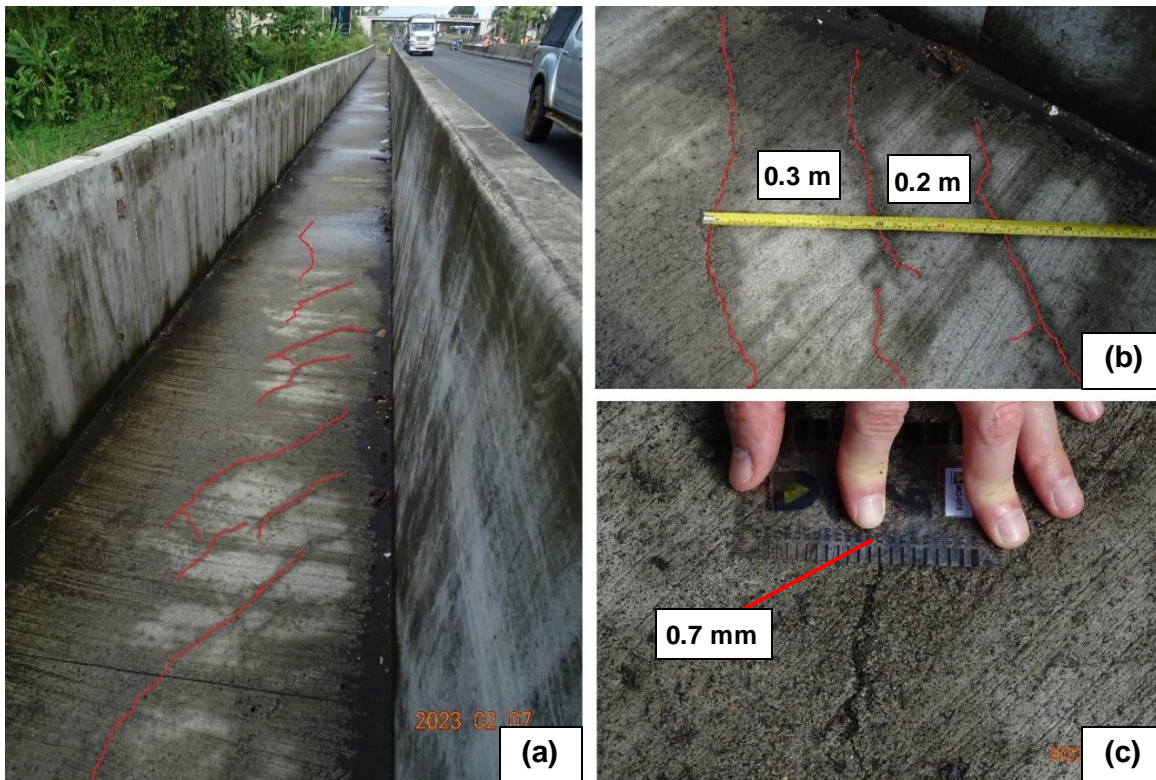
Agrietamiento de la sobrelosa de concreto del tablero del puente nuevo sobre el río Guácimo, en la zona de la acera peatonal. (a) Vista general. (b) Espaciamiento entre grietas de aproximadamente 0.2 m a 0.3 m. (c) Espesor de grieta aproximado de 0.7 mm.
